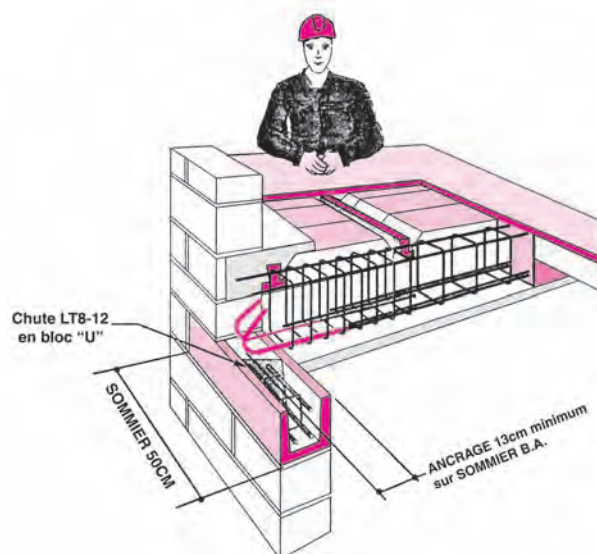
Vue d'une poutre appuyée sur un sommier en béton armé
